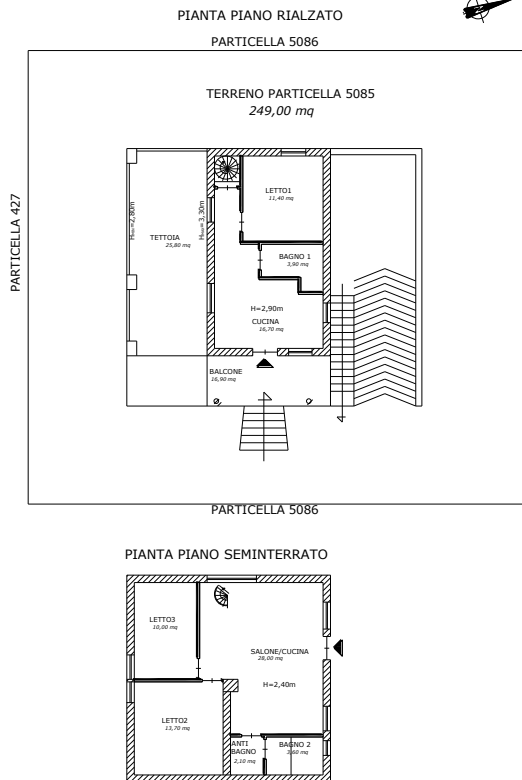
planimetria del piano rialzato e del piano seminterrato della villetta
